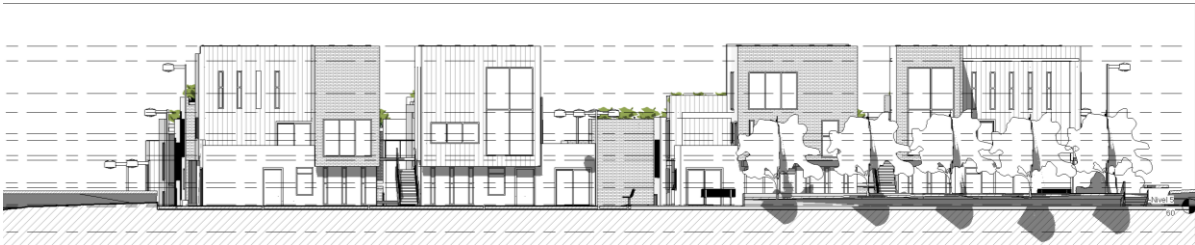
Corte Urbano B-B. vista por.... Fuente: Propia
